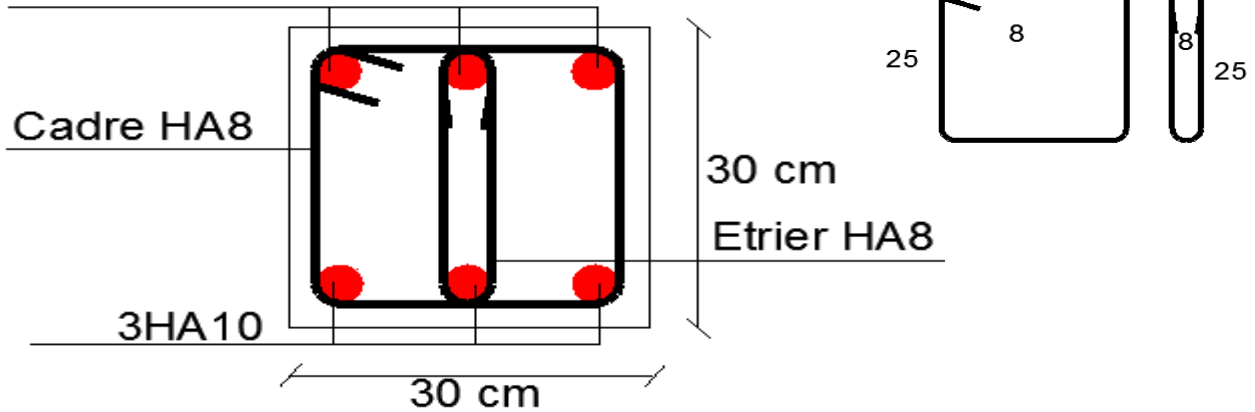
Schéma de ferrailage de la poutre de chaînage
